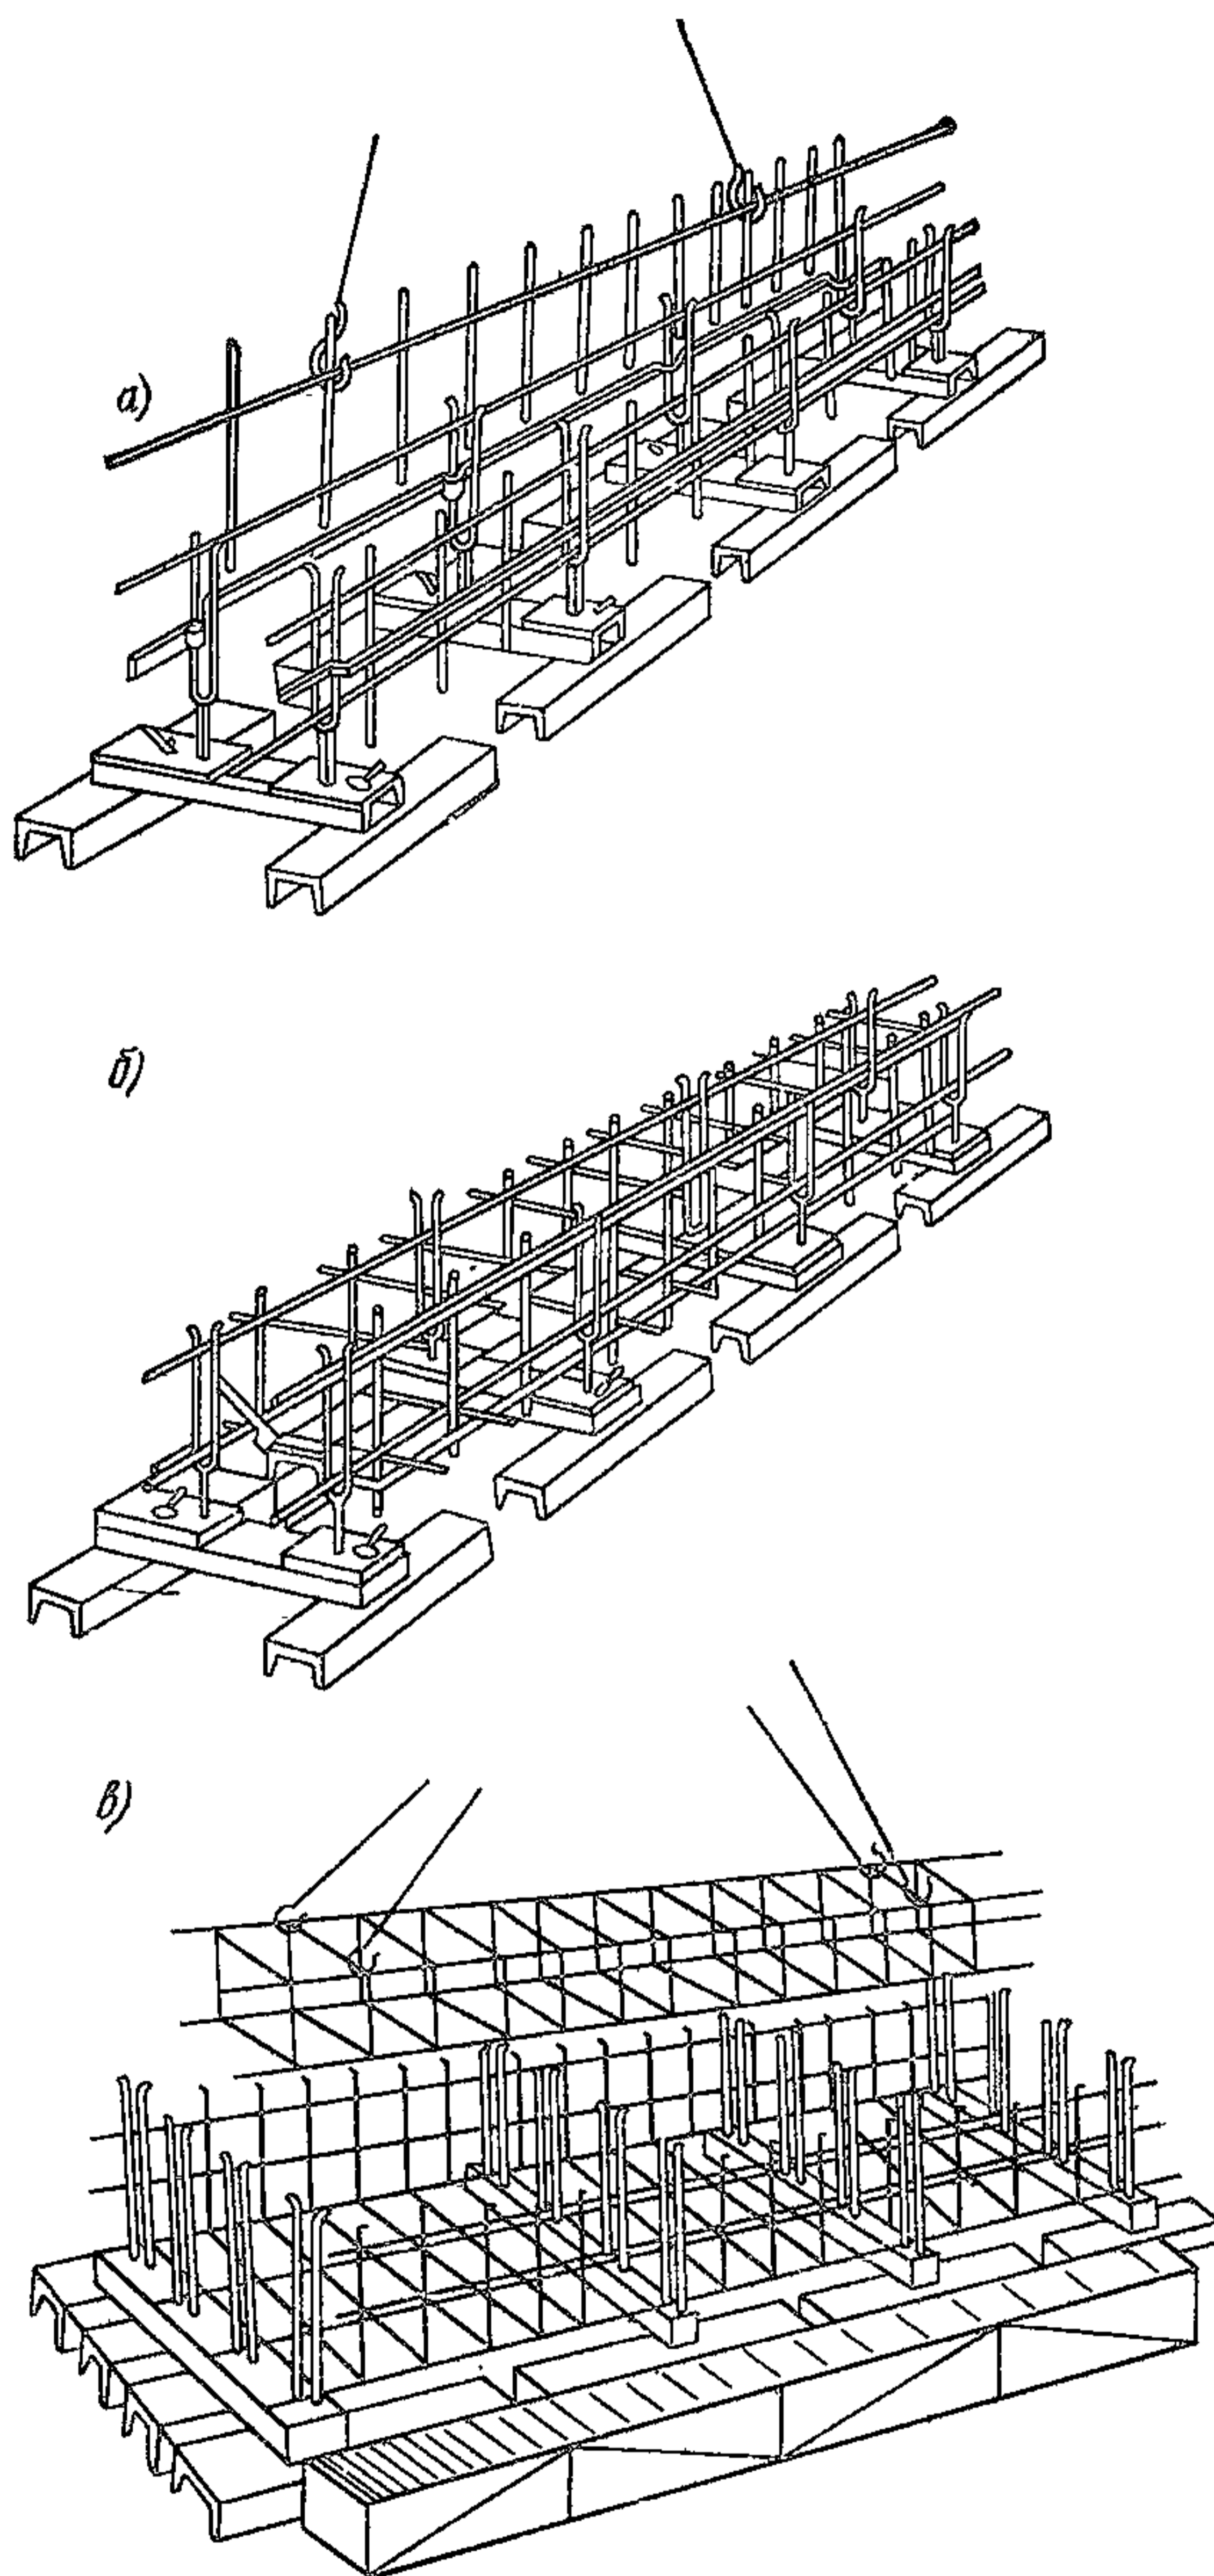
Кондуктор для сварки и сборки каркаса
